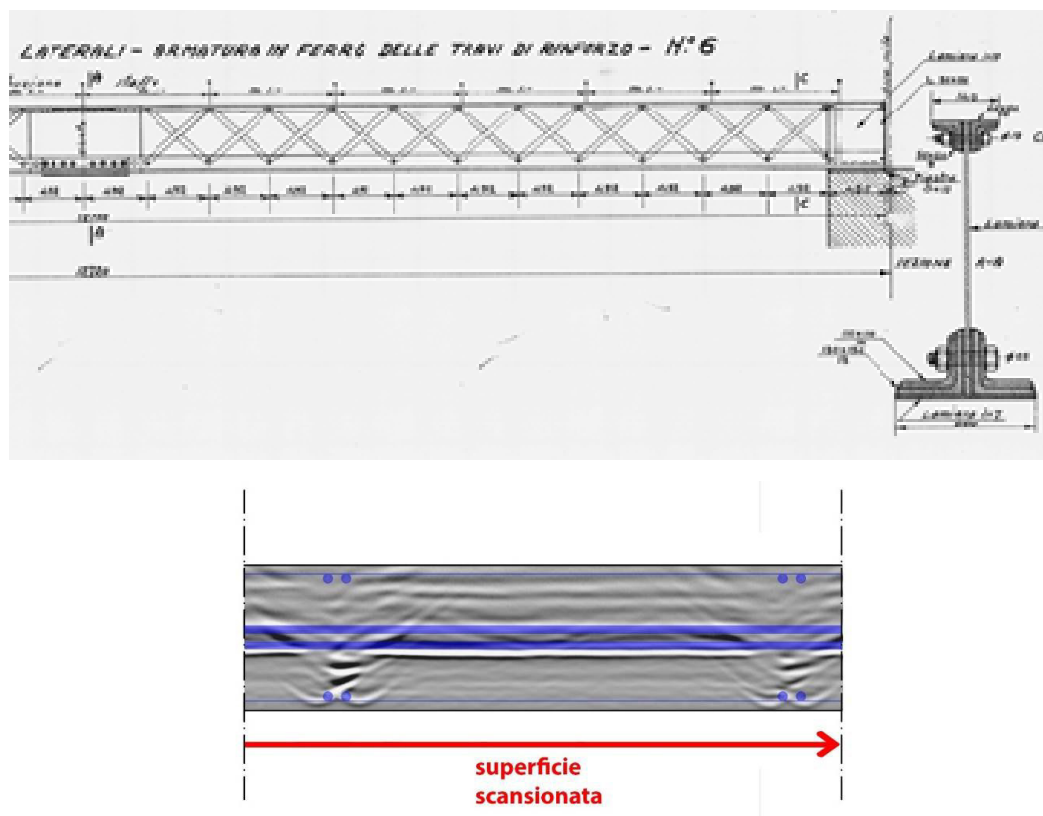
Sezione long. verticale di progetto ed orizzontale ipotesi ricostruttiva
